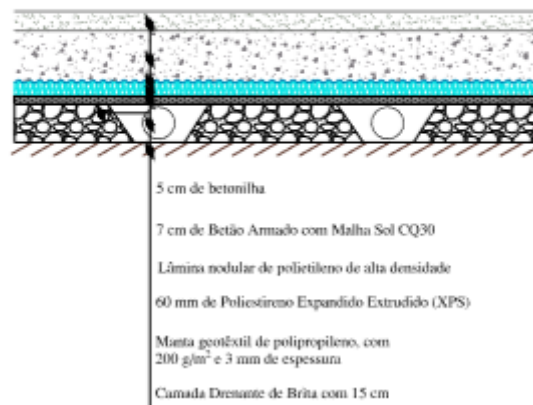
Pormenores construtivos dos pavimentos e coberturas (desenho fornecido pela empresa DMF).
